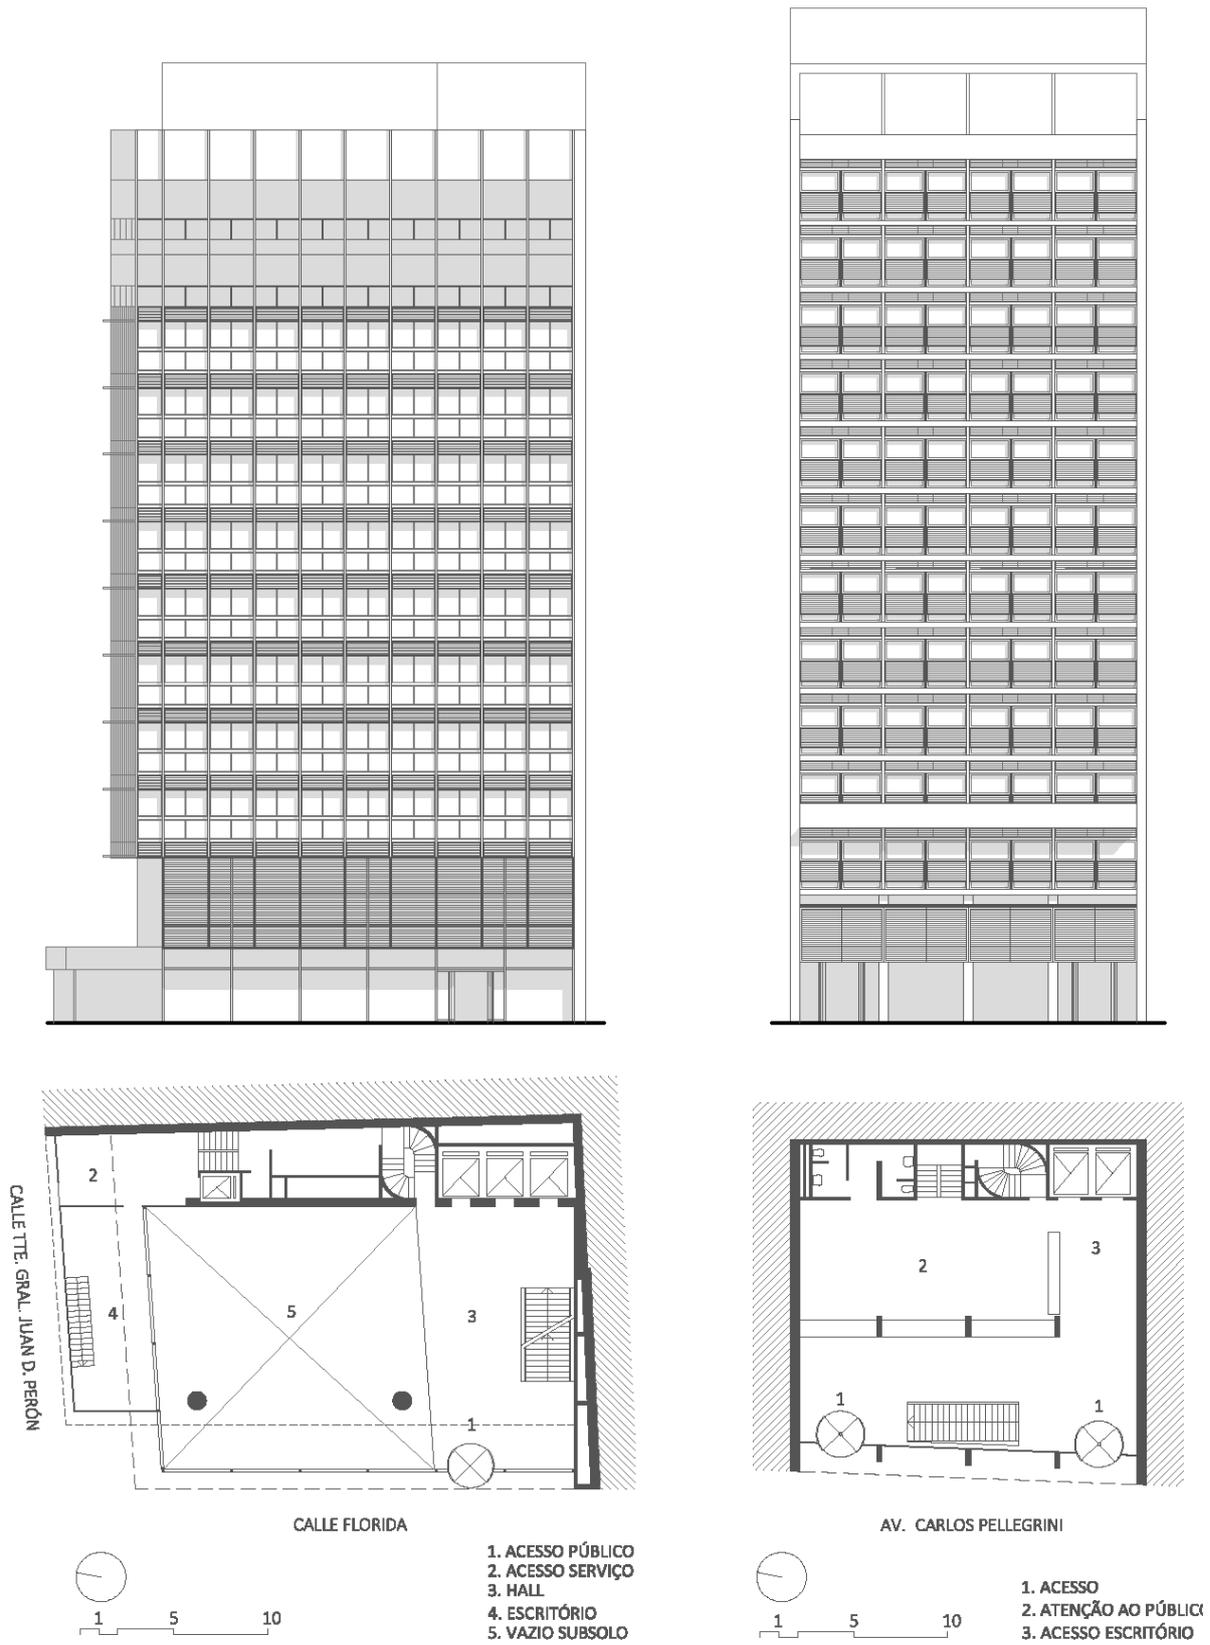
Elevação oeste e Planta Baixa do Térreo, Banco Popular Argentino, 1962 – 1968.
